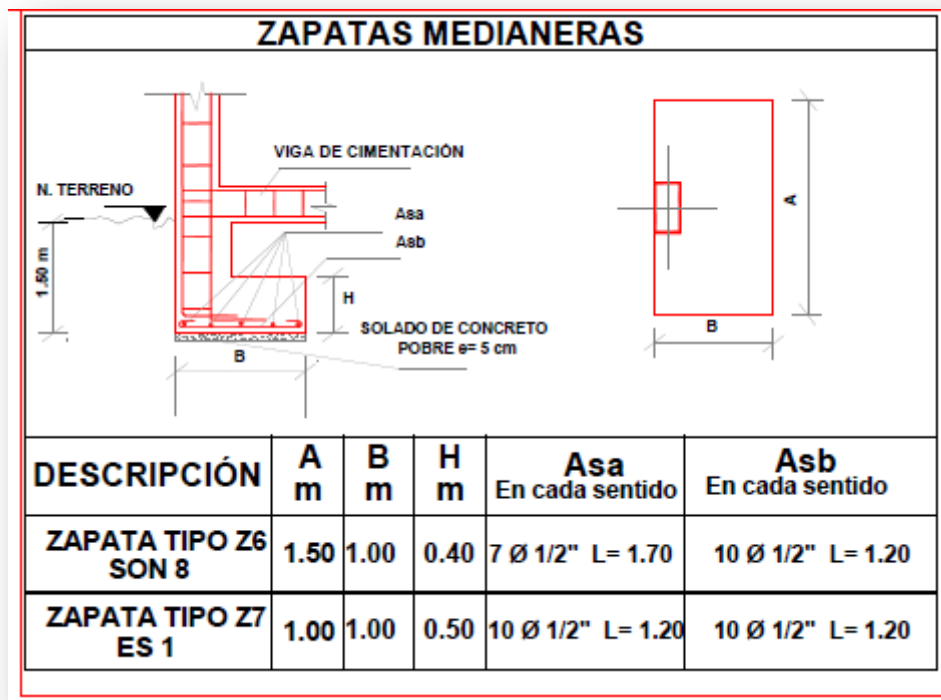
Detalles de Zapata. Fuente: Ing Diego Quiroga
